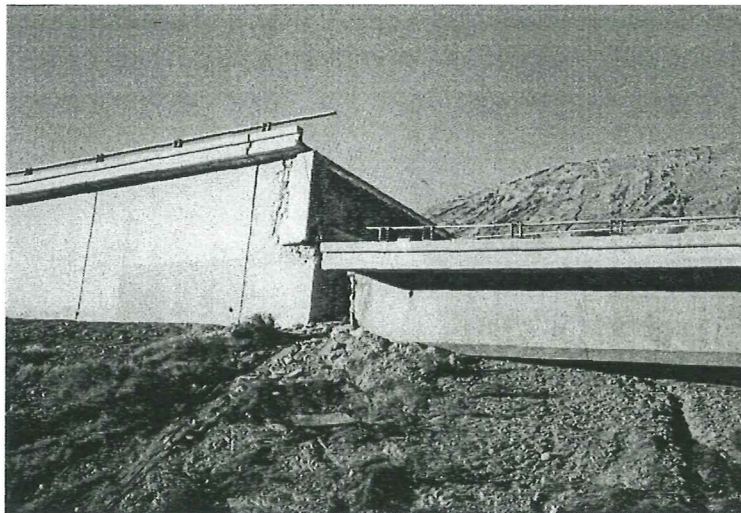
Fallo en el estribo número uno, (Priestley *et al.*, 1994).
